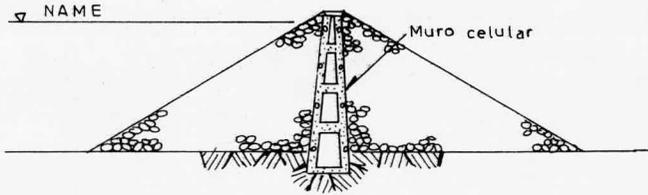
Sección de cortina de enrocamiento con muro celular.
